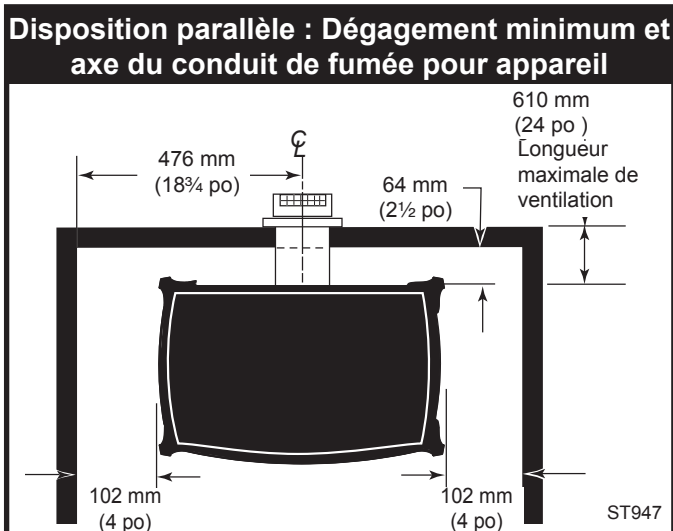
Disposition parallèle, espaces de dégagement latéral et arrière minimum et axes du conduit de fumée.
